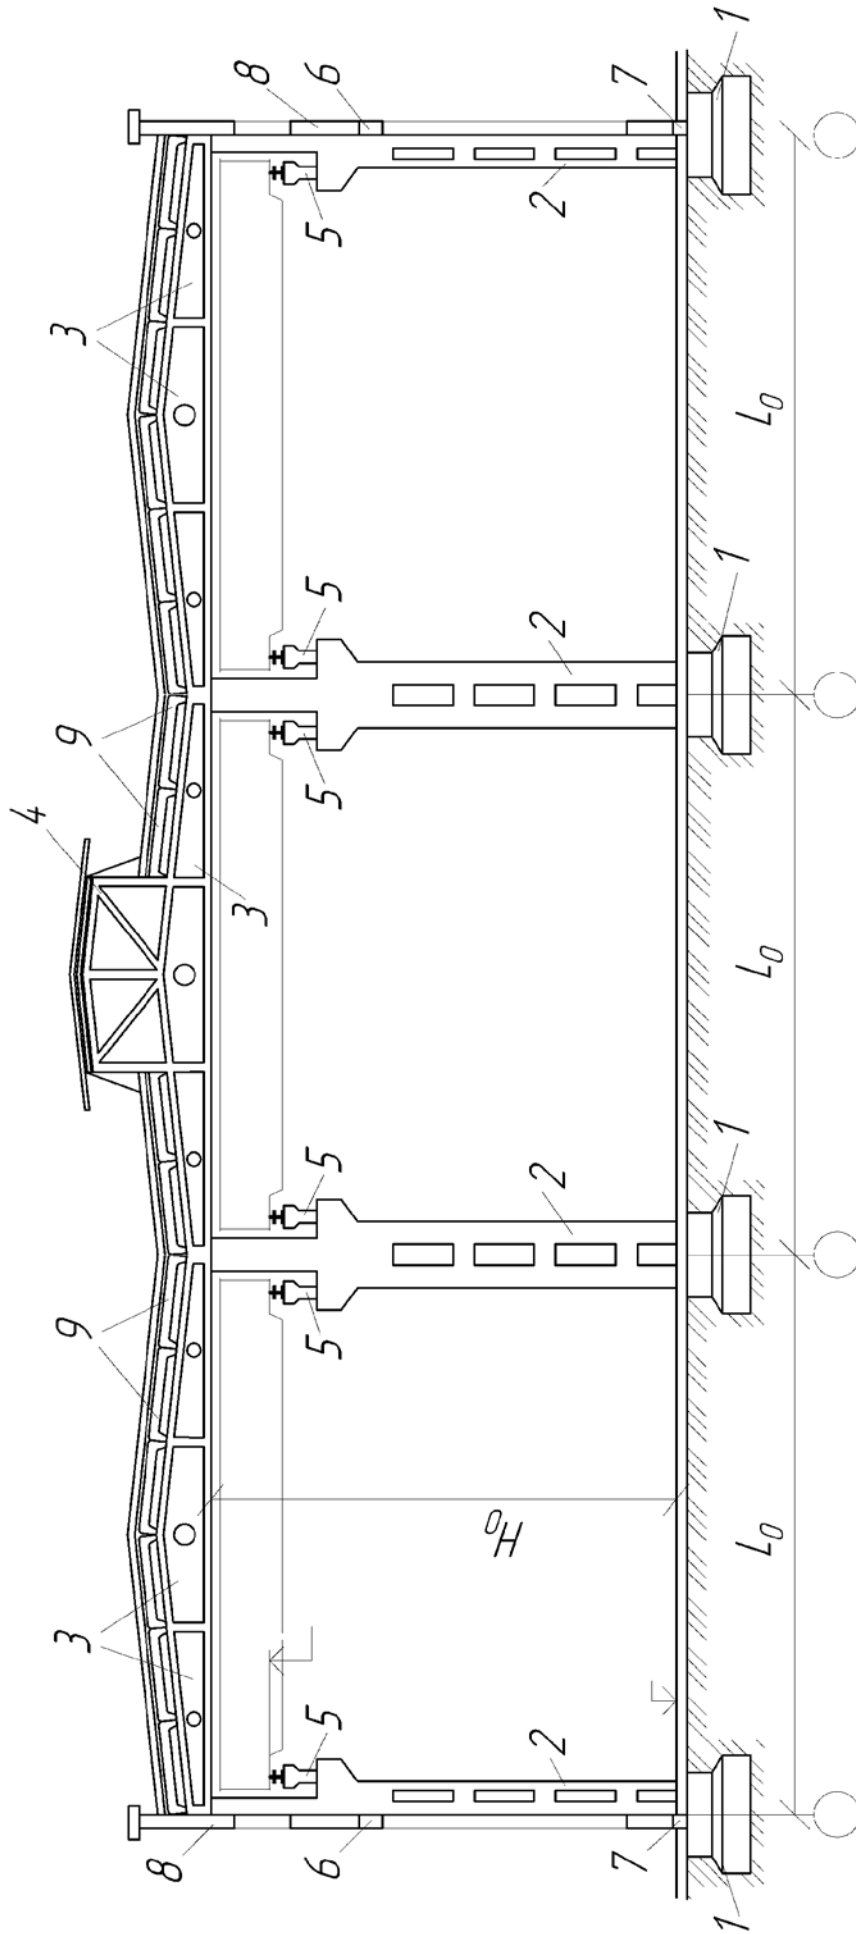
Схема поперечного разреза одноэтажного многопролетного промышленного здания с железобетонным каркасом
